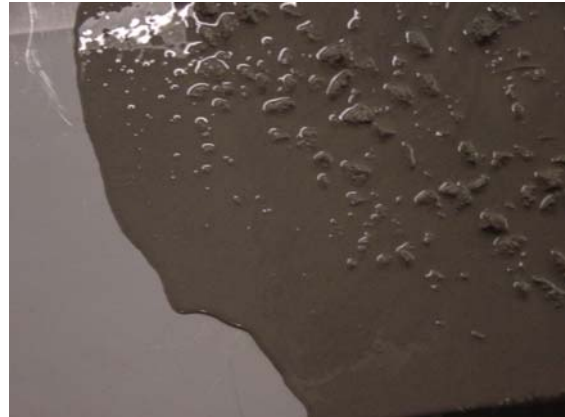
Pormenor da fronteira do círculo de betão espalhado.
